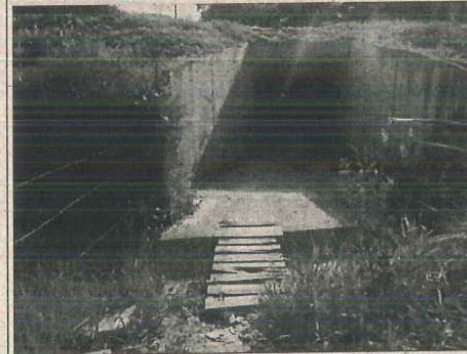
Adequar entrada da passagem de fauna situada no km 49+350 (implantar passarela de concreto). Vão formado por sistema de drenagem dificulta ou não permite a entrada de animais. A ponte de madeira é uma medida temporária.
